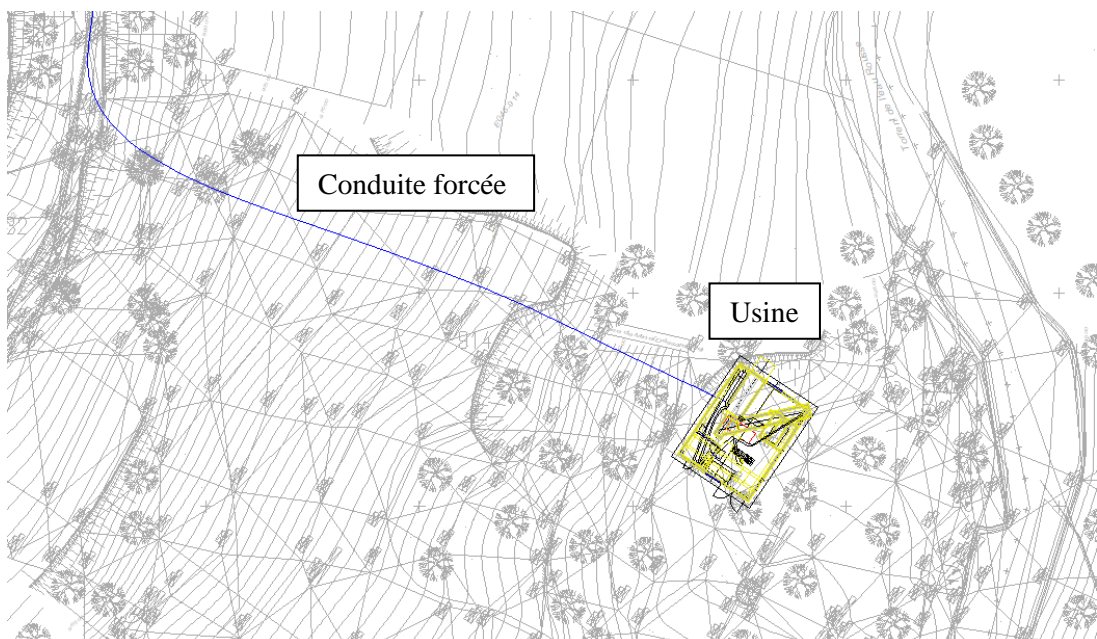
Implantation conduite forcée sur fond cadastral (6)
